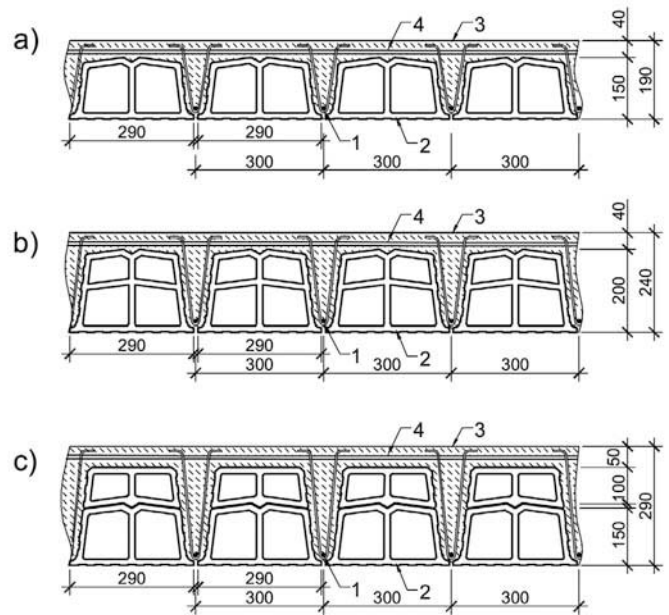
Strop GKN: 1 – zbrojenie żebra, 2 – system deskowania stropu typu T-Forms, 3 – beton, 4 – siatka zbrojeniowa górnej płyty
